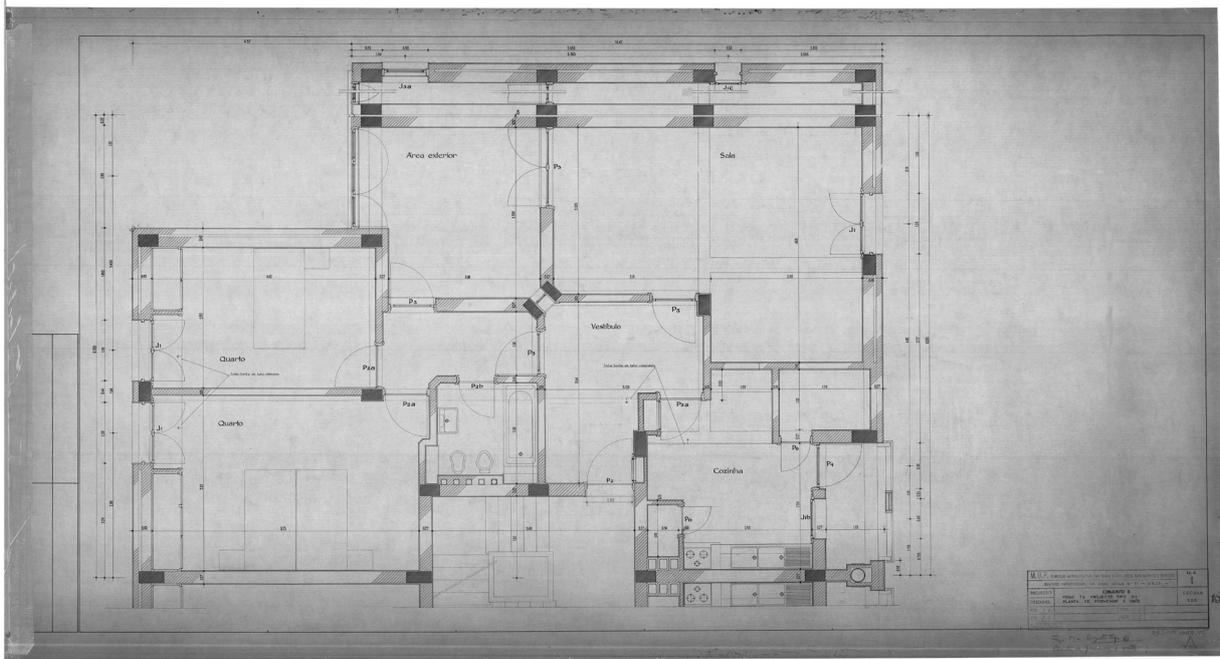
Projeto: fogo T3 – projecto tipo G1, planta de pormenor e vãos
